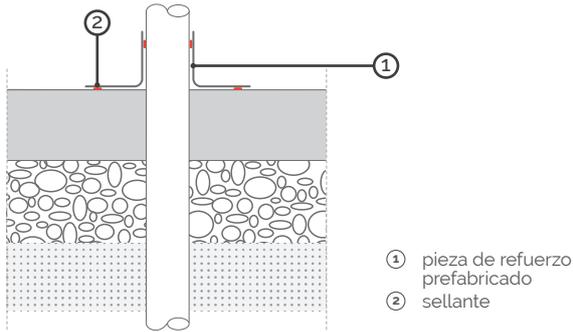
Encuentro del cerramiento con un elemento pasante vertical resuelto con una pieza de refuerzo prefabricada
